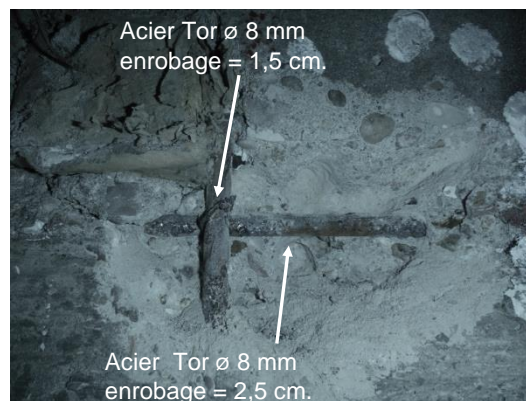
ouverture sur aciers au niveau de la retombée de la poutre
